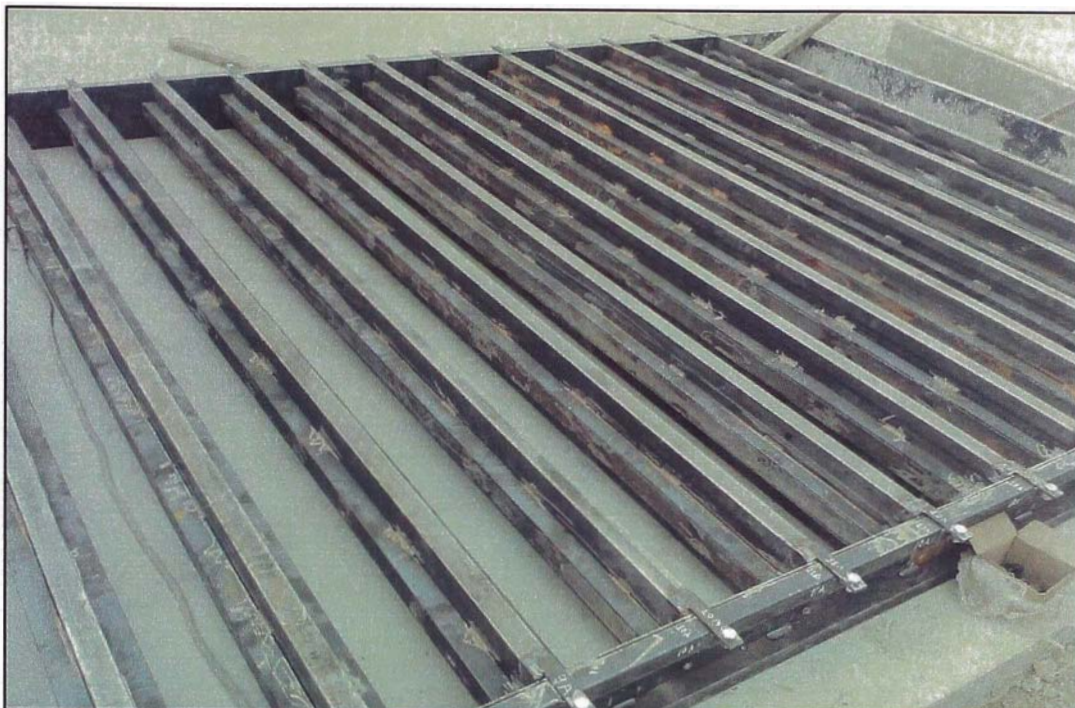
Encofrado para columnas prefabricadas de concreto
